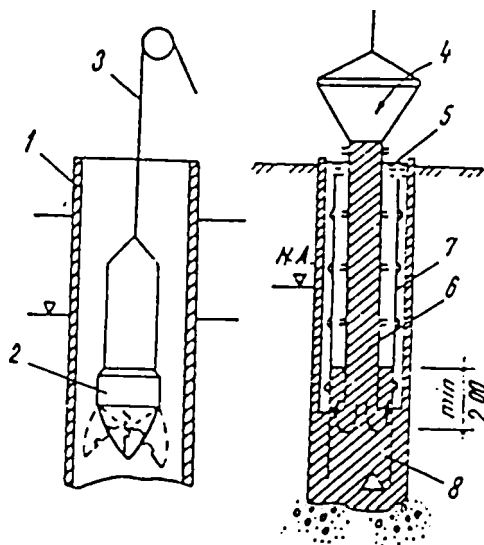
Dispozitiv de săpare și betonare Benoto:
